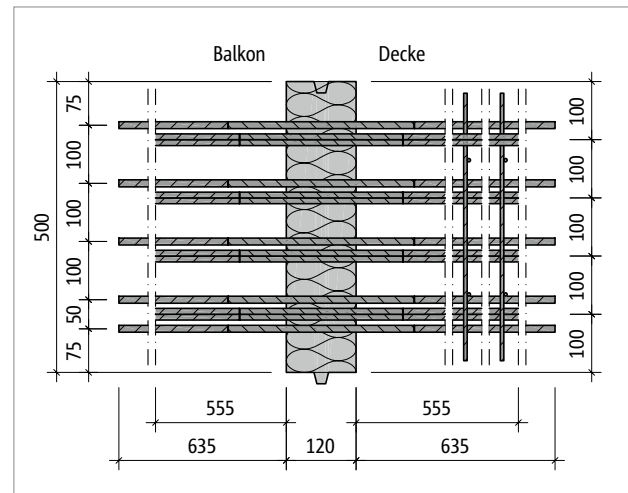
Schöck Isokorb® XT Typ DP-MM4-VV4: Grundriss
